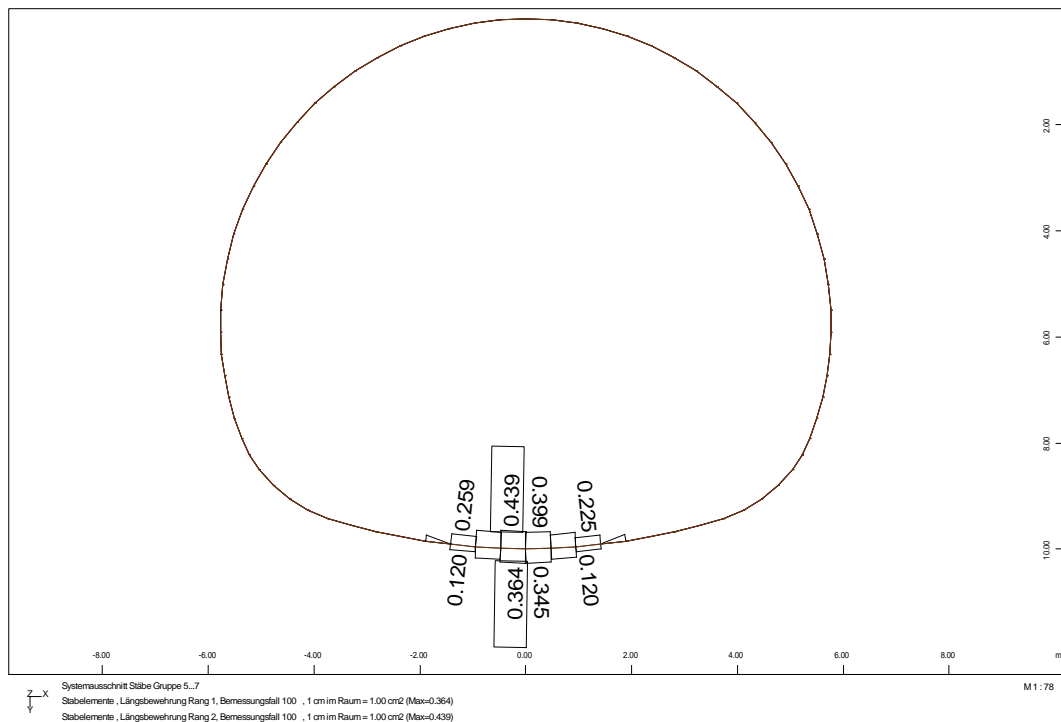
statisch erforderliche Biegebewehrung der Außenschale
